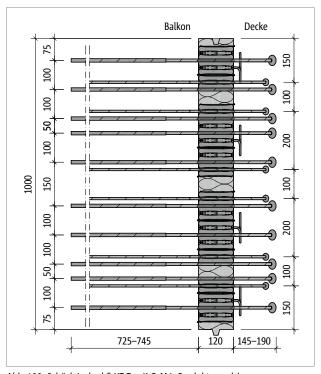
Schöck Isokorb® XT Typ K-O-M4: Produktgrundriss
